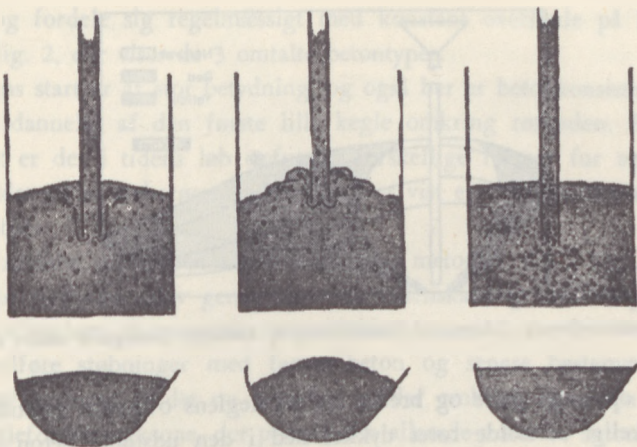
Betonkonsistensens indflydelse på støbningen, visende fra venstre: god konsistens, for tør beton og for blød beton eller dårlig graduering.
